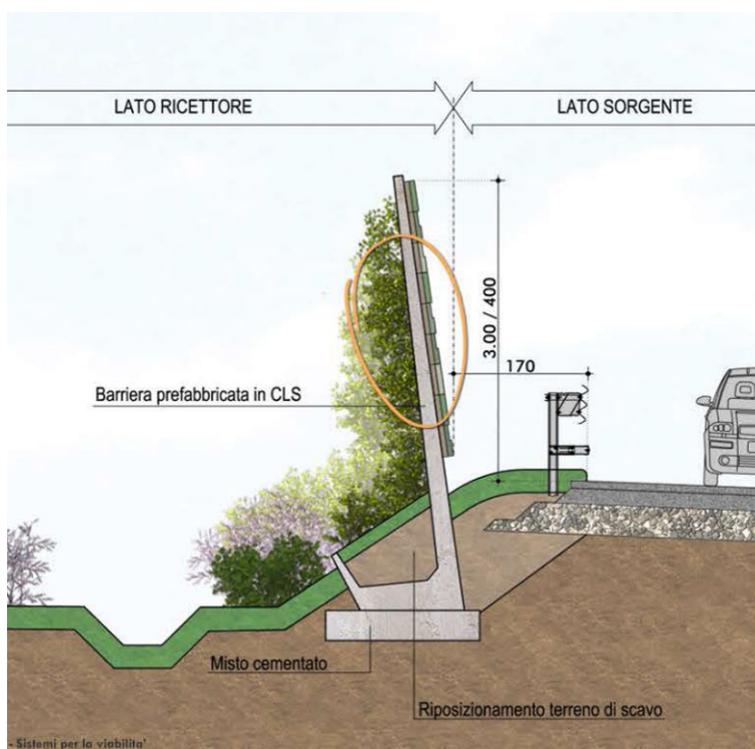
Esempio di sezione tipo su rilevato con barriera opaca fonoassorbente lato sorgente
